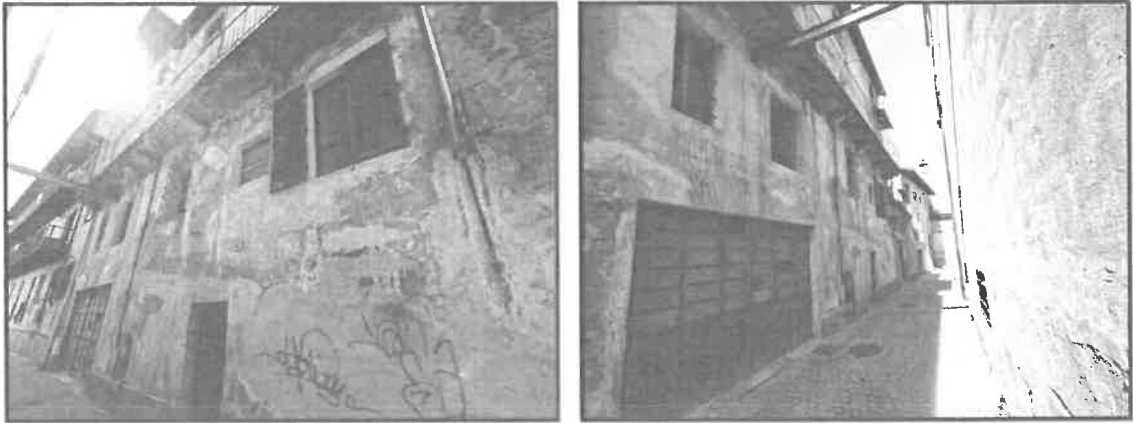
6 prospetto del fabbricato da Via Rocciamelone
